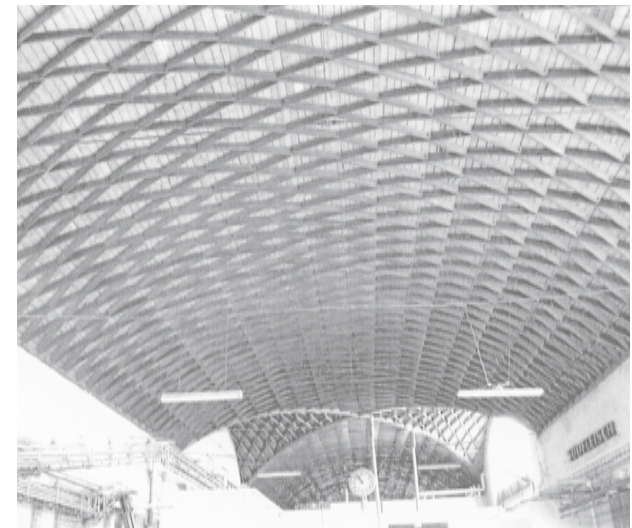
Dachkonstruktion der Verkehrshalle in „Zollinger-Lamellenbauweise“
